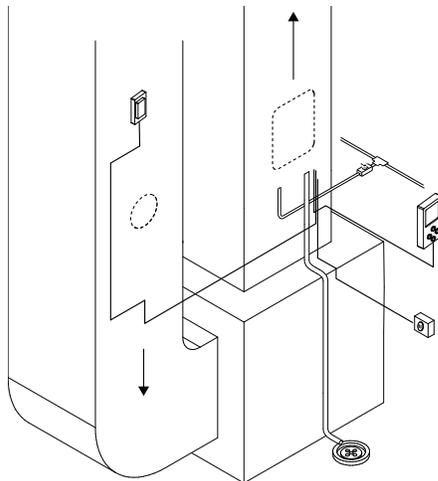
Emplacement de montage. Il est également possible d'installer l'humidificateur sur la conduite de retour d'air.
